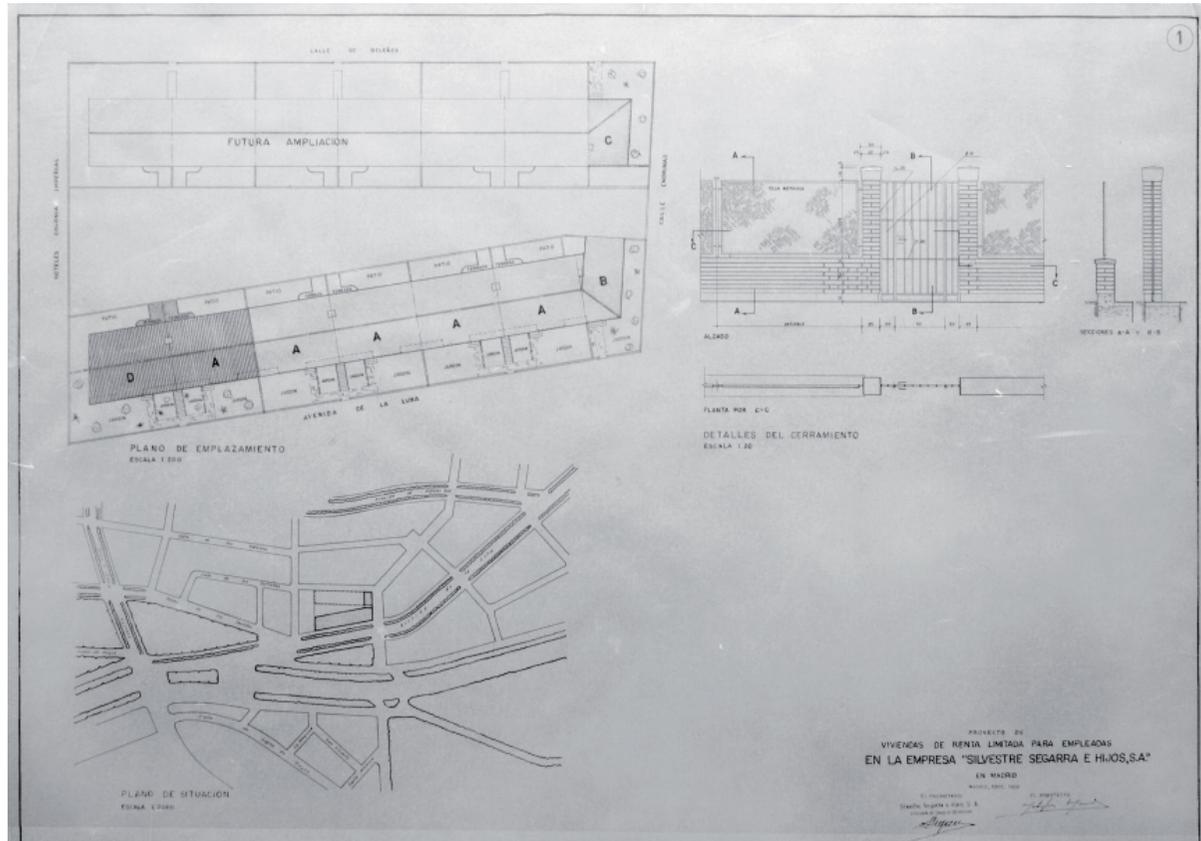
Plano de situación y emplazamiento de proyecto de viviendas para la dependencia
